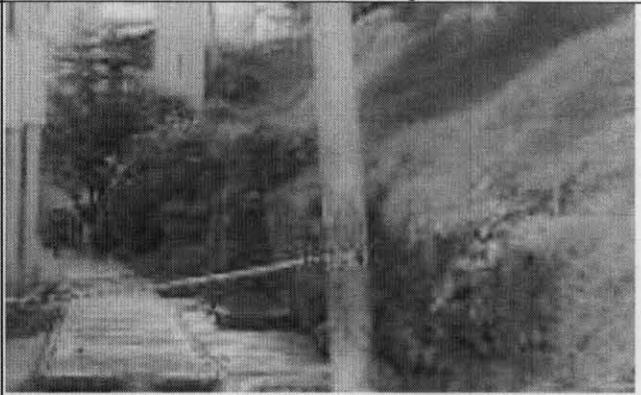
Coronas y escarpes de deslizamiento además de agrietamientos en el talud.
